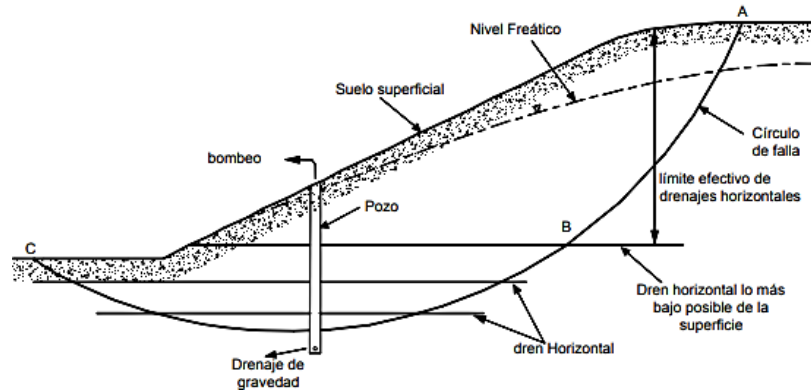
Principio de un sistema de pozo vertical con drenes horizontales para la estabilización de los deslizamientos
